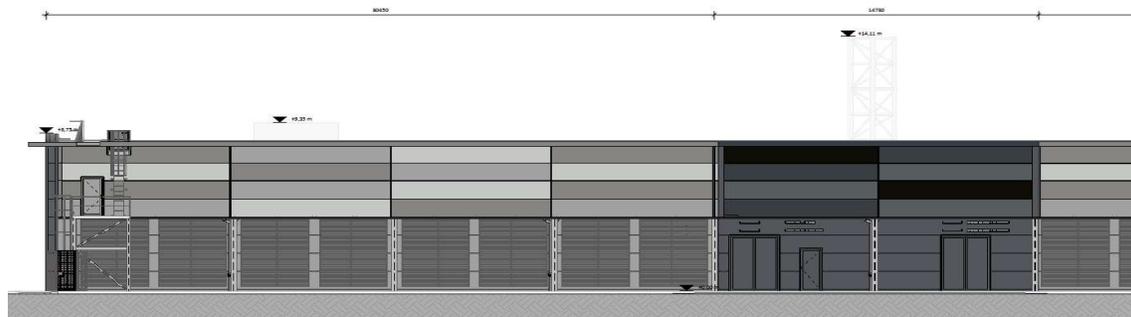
Concetto di suddivisione delle facciate – stralcio prospetto nord
